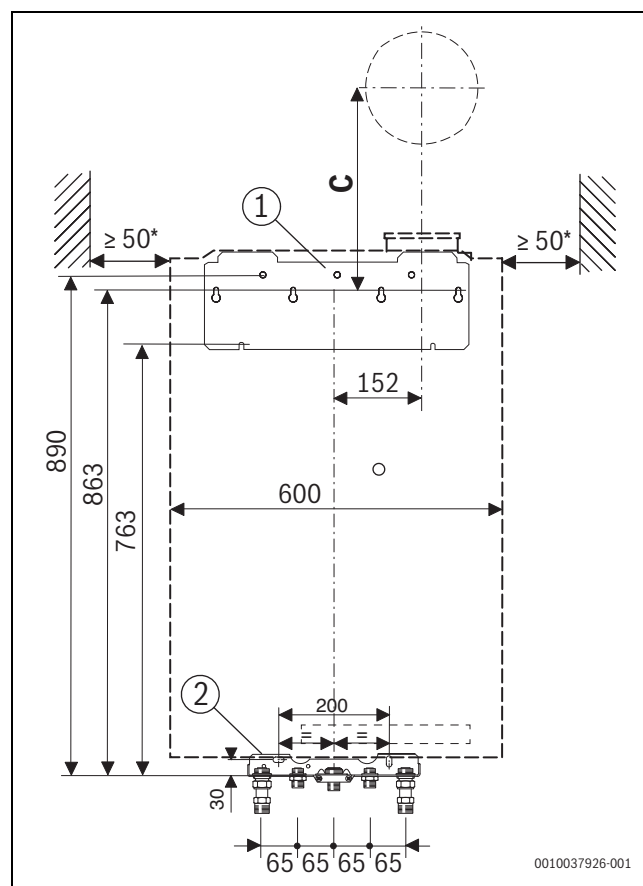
Pohľad spredu, vodorovná hydraulická prípojka (mm)
